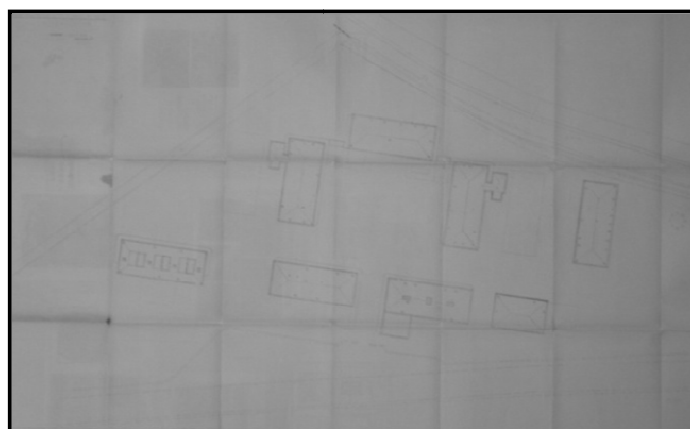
Plan d'ensemble initial- plan de la terrasse. Source: Les archives de la DUC de Sétif.
